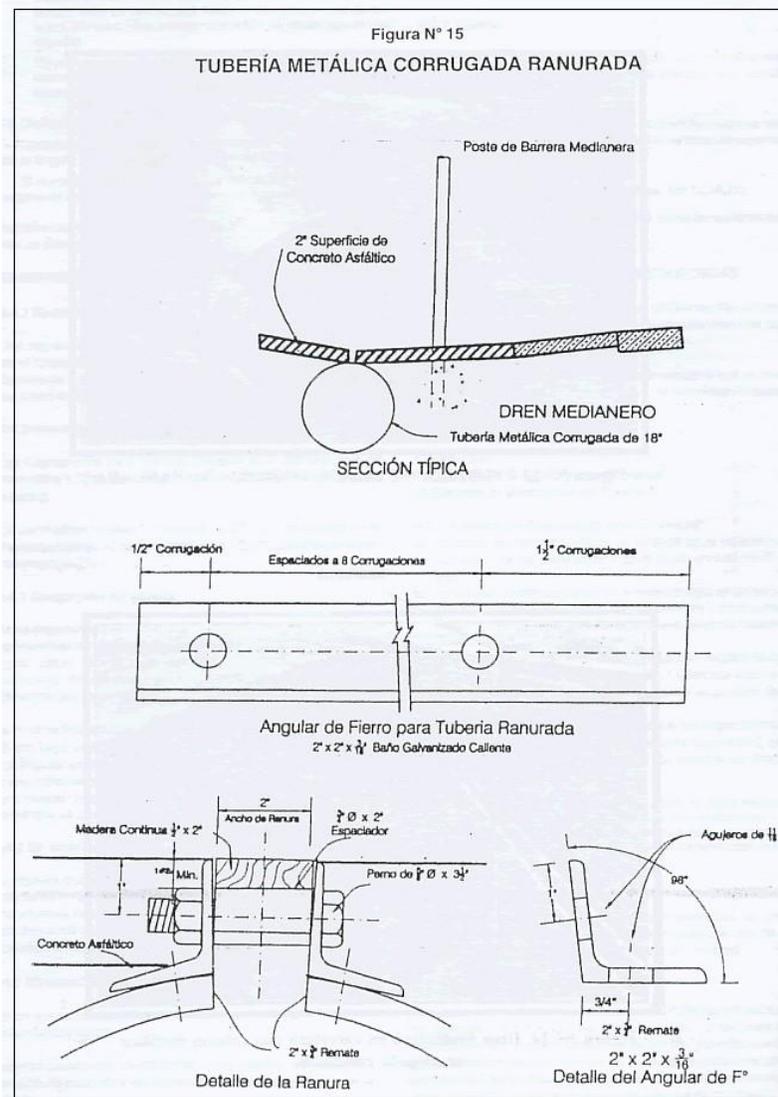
, Dren Medianero en carretera con tubería metálica corrugada ranurada.
